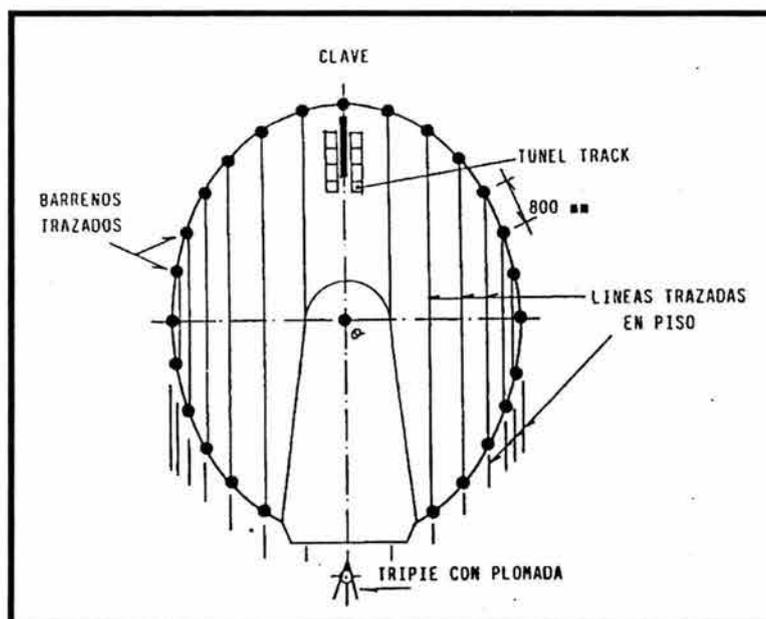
TRAZO DE LA SECCIÓN DE EXCAVACIÓN
